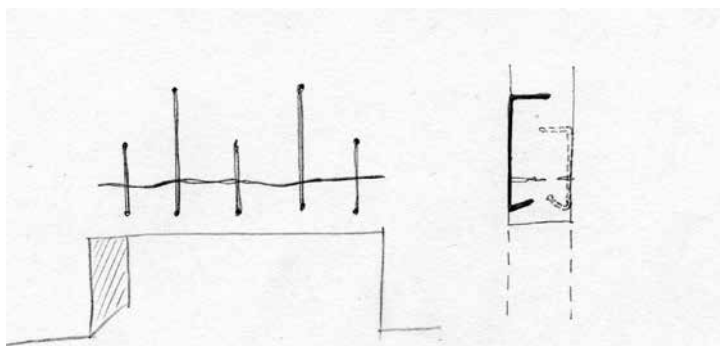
Ilustração esquemática de reabilitação de fissuras - Ficha A4.
